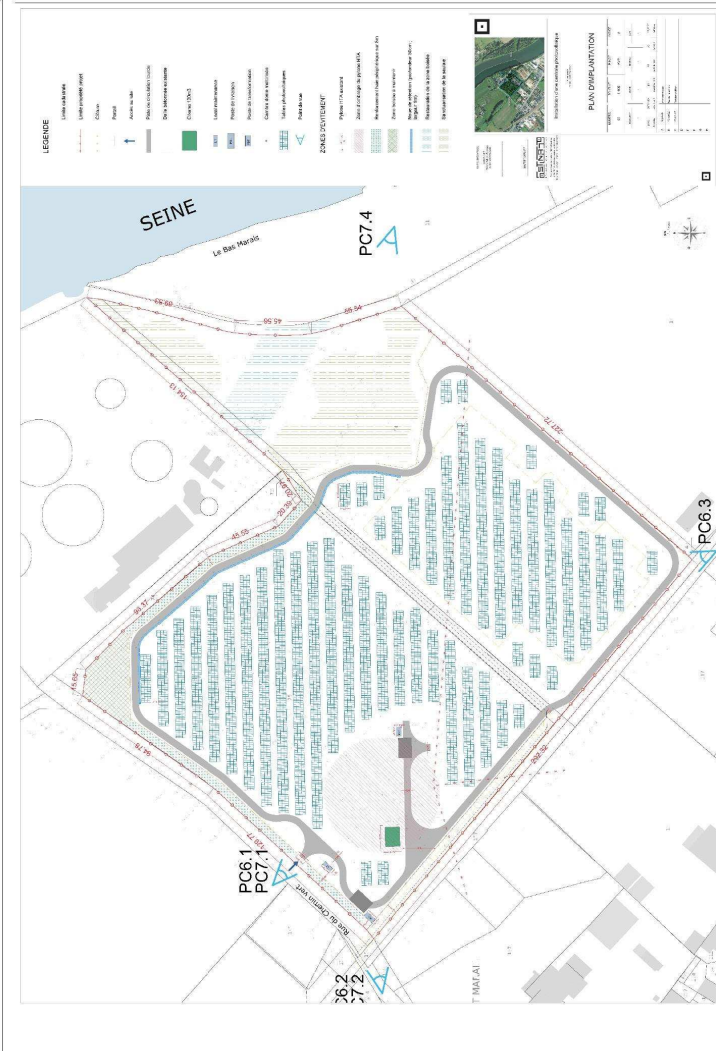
Plan masse du projet en juillet 2022 (Source : URBASOLAR)
